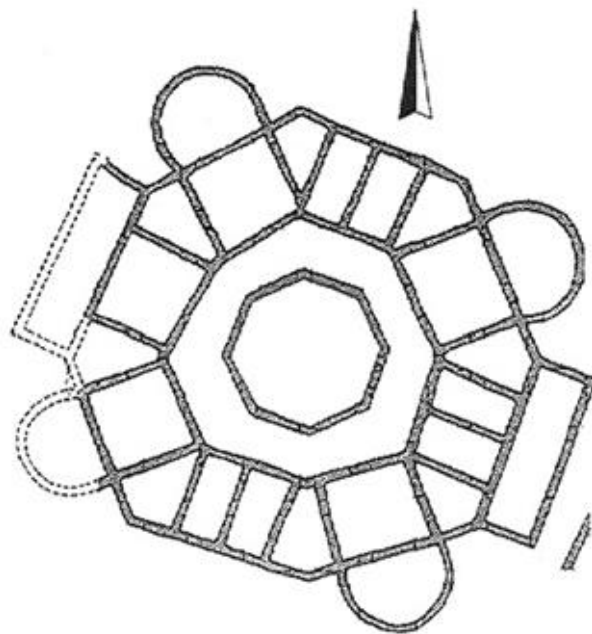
Planimetría de la *villa* de Valdetorres del Jarama (Madrid).
